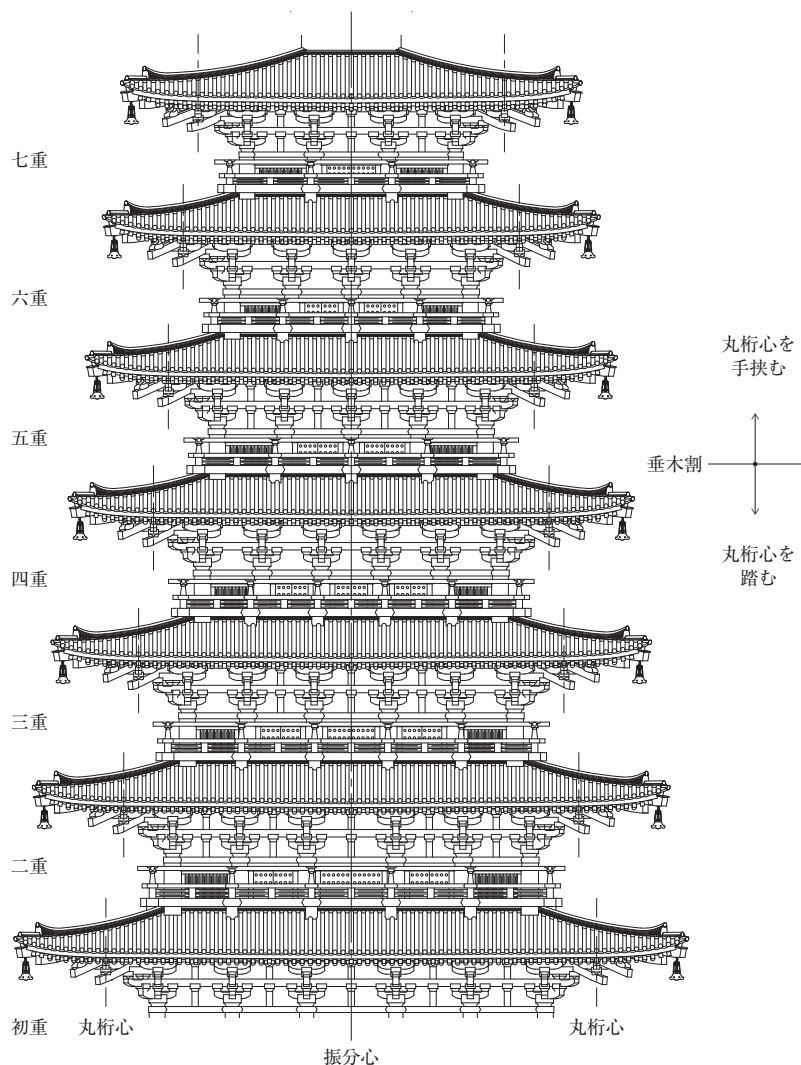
天平塔 軒・屋根立面図 1 : 300
